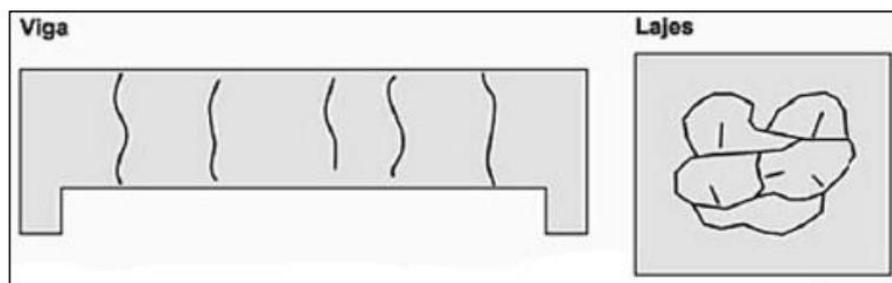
Fissura do concreto por retração hidráulica.
